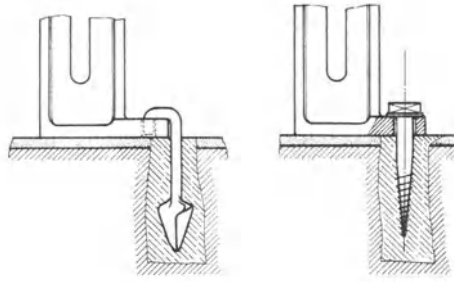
Haken- und Schraubenbefestigung der Stühle.
